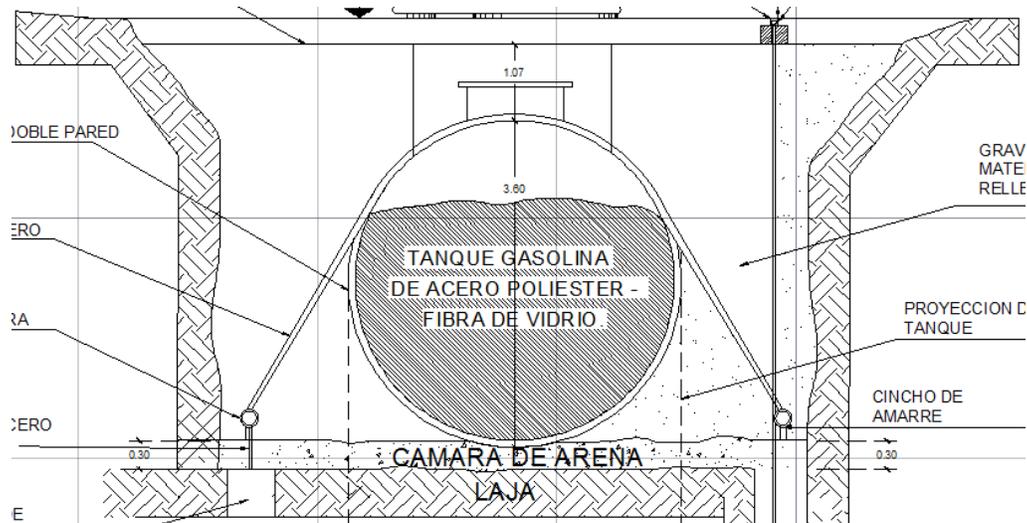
Diseño de fosa con cama de arena para la colocación de tanques de almacenamiento, no menor a 30 cm (extracto de plano "Instalaciones mecánicas clave IM-01").
